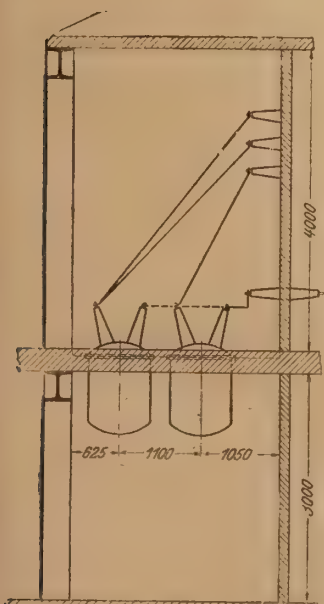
20 kV-Ölschalter der Siemens-Schuckert Werke.
